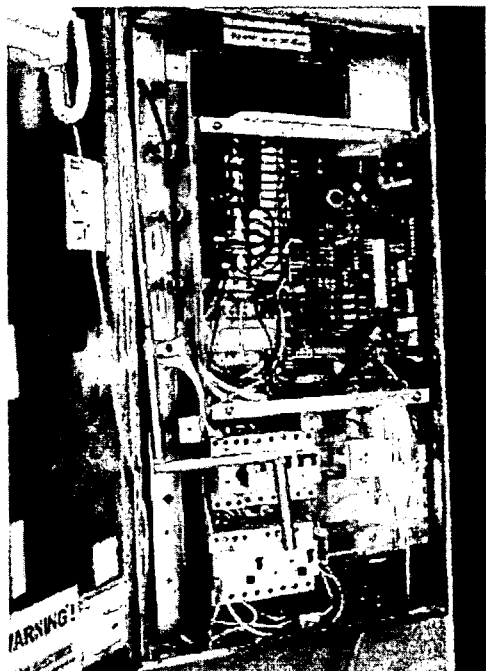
Контроллер с рычагами выключения тормоза и ручного привода
